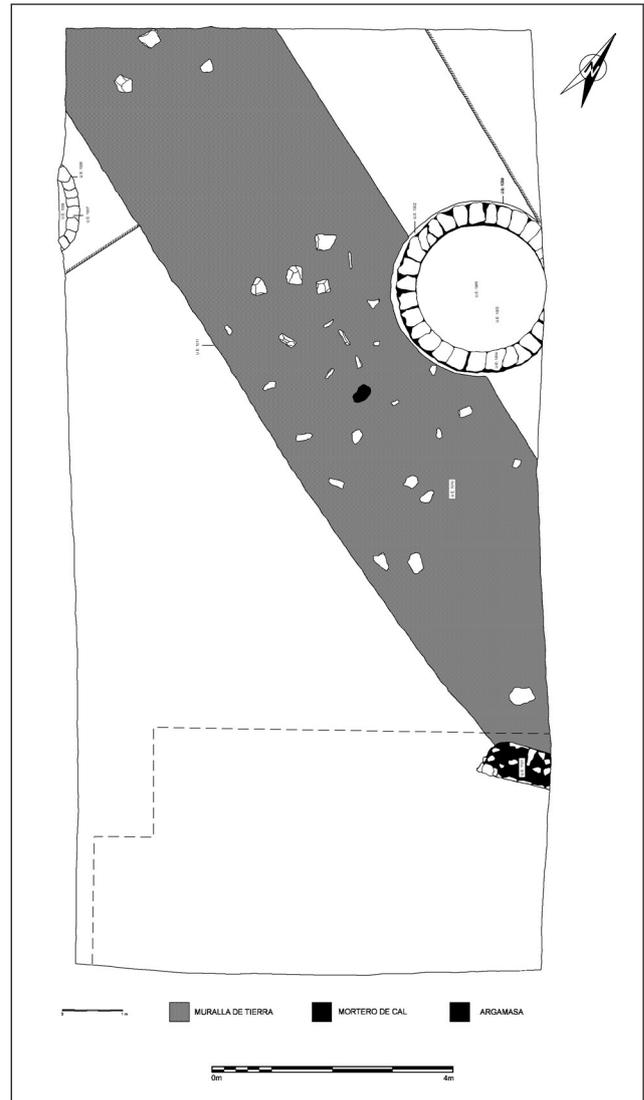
Planimetría de la muralla de la C/ Caballero 13-17.
